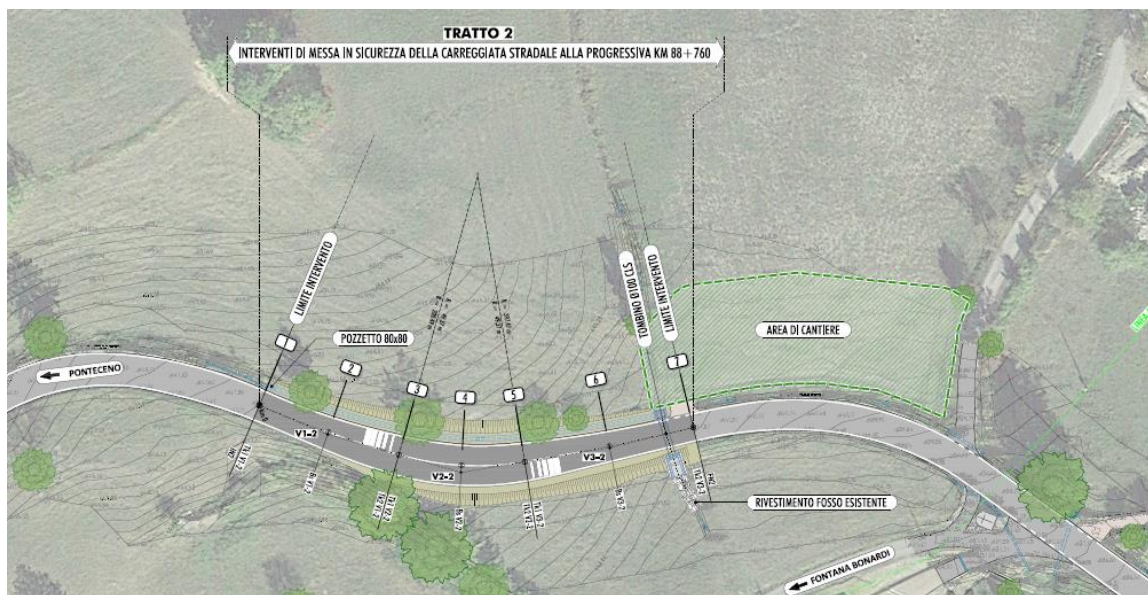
INTERVENTO TRATTO 2 – STRALCIO PLANIMETRICO
